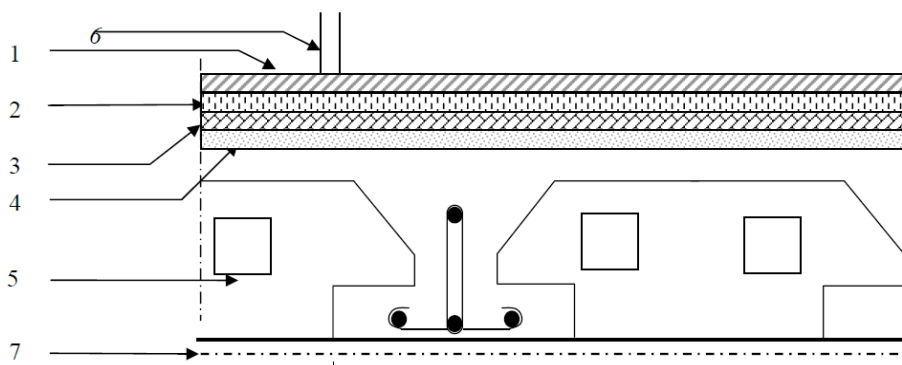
Coupe plancher étage courant (RDC+Sous-Sol)
